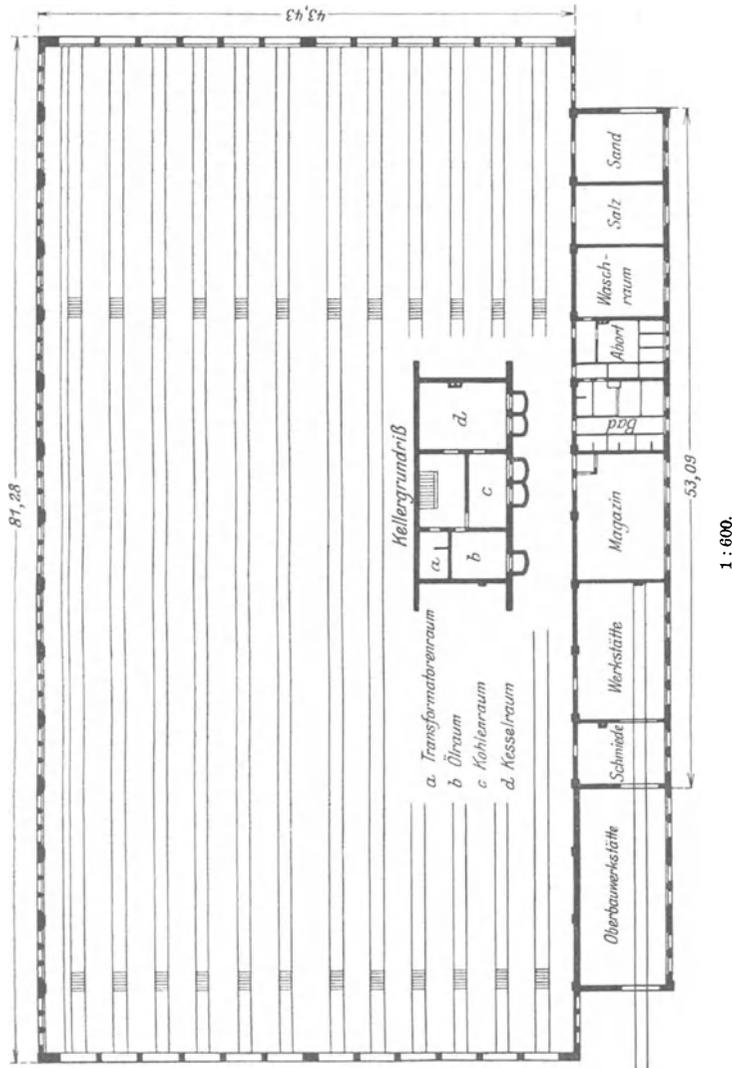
Abstellbahnhof an der Waldhofstraße in Mannheim. Wagenhalle mit Anbauten.
